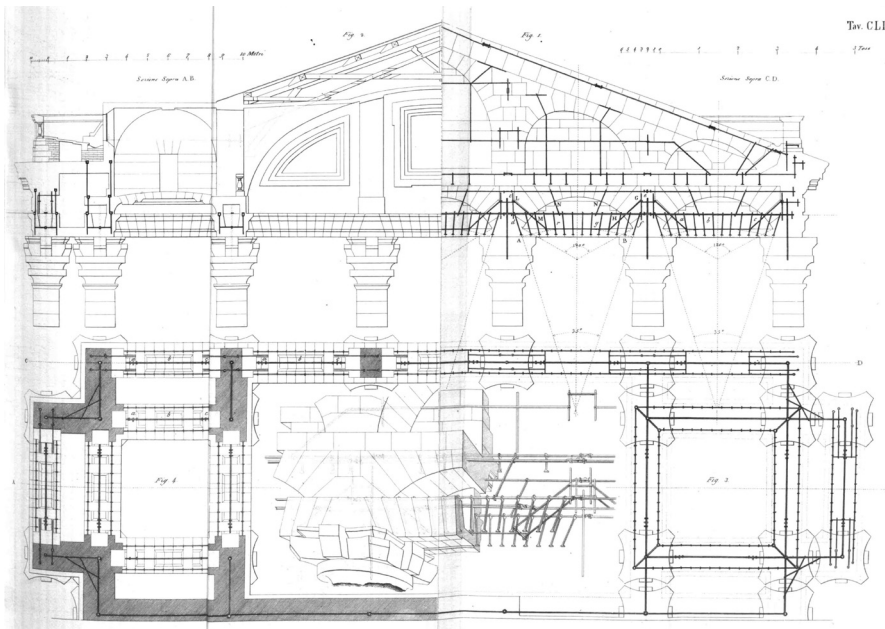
Armatura del portico della Chiesa di Sainte-Geneviève⁵⁹. Piante, sezioni e profilo della costruzione delle piattabande e del plafone del portico.
